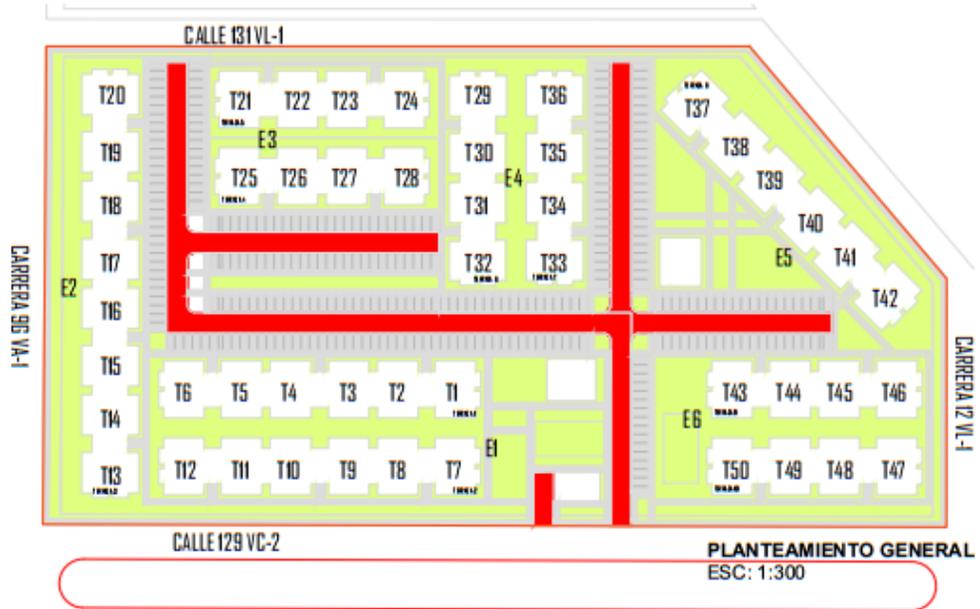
Plano en planta del proyecto Palmas del Caribe II (Equipo técnico ACF SAS)
